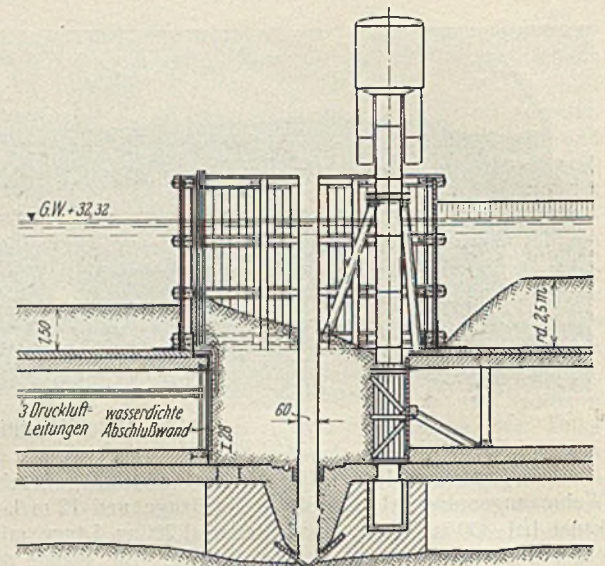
Senkkasten 2 fertig abgesenkt. Druckluftbeton eingebracht.
